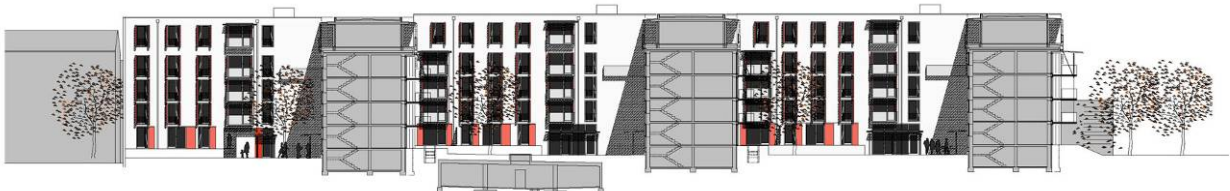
Hoffassaden mit großzügigen Öffnungen zu den Wohnhöfen (Felix + Jonas Architekten)
